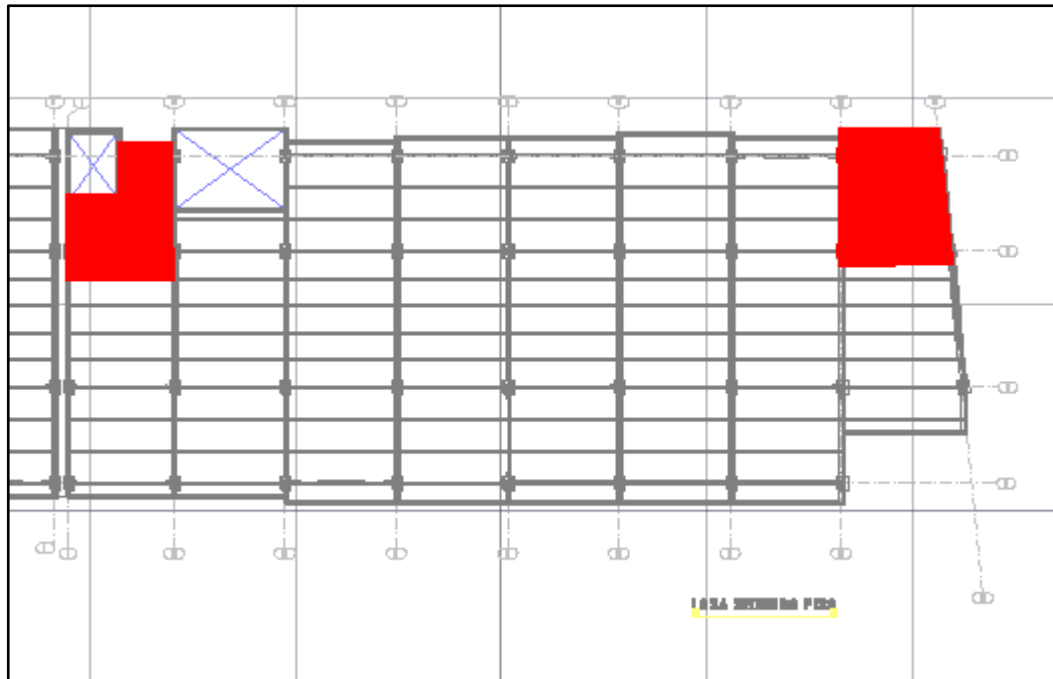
Localización de losas nivel 2. Fuente: plano de planta y alzada 14.0.
